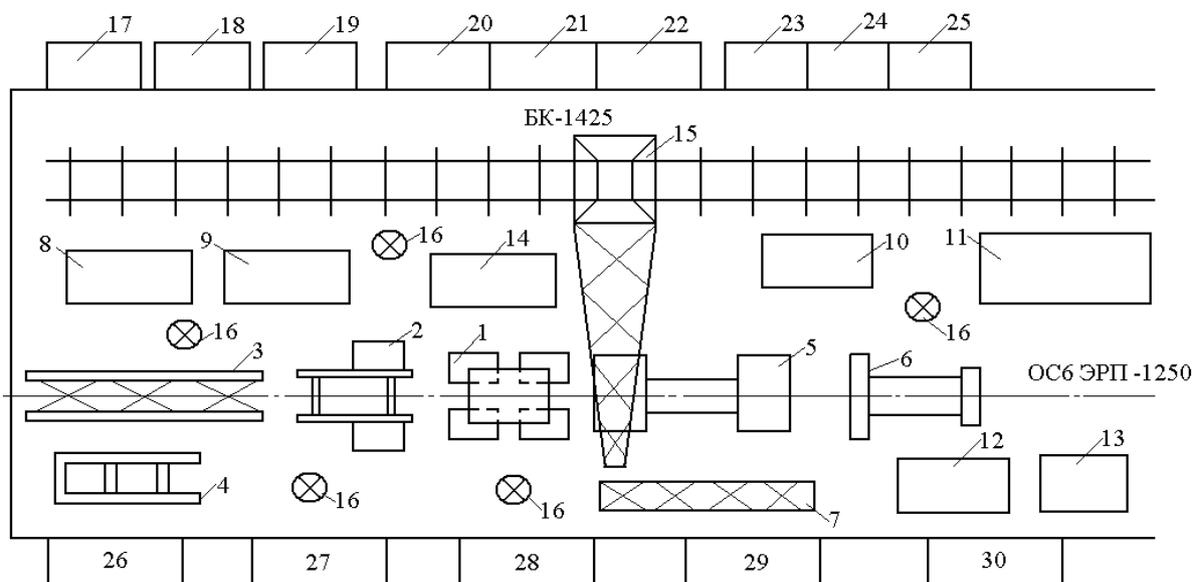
Схема монтажной площадки для монтажа ЭРП-1250: 1 – база; 2 – задний портал; 3 – стрела; 4 – передний портал; 5 – нижняя надстройка; 6 – консоль противовеса; 7 – разгрузочная консоль; 8 – площадка для сборки ротора; 9 – площадка для сборки ходовой части; 10 – площадка для сборки поворотной платформы; 11 – площадка для узлов деррик-кранов; 12 – площадка для бункера и перегружающего устройства; 13 – управляющие кабины; 14 – поворотная платформа; 15 – кран БК-1425; 16 – грузоподъемные краны; 17 – контора шефского персонала; 18 – технический архив; 19 – контора генерального подрядчика; 20 – ремонтно-механические мастерские; 21 – инструментальная; 22 – склад; 23 – контора механомонтажников; 24 – гардеробная и душевая; 25 – столовая; 26 – котельная; 27 – склад электрооборудования; 28 – контора заказчика; 29 – контора электромонтажников; 30 – контора наладчиков
